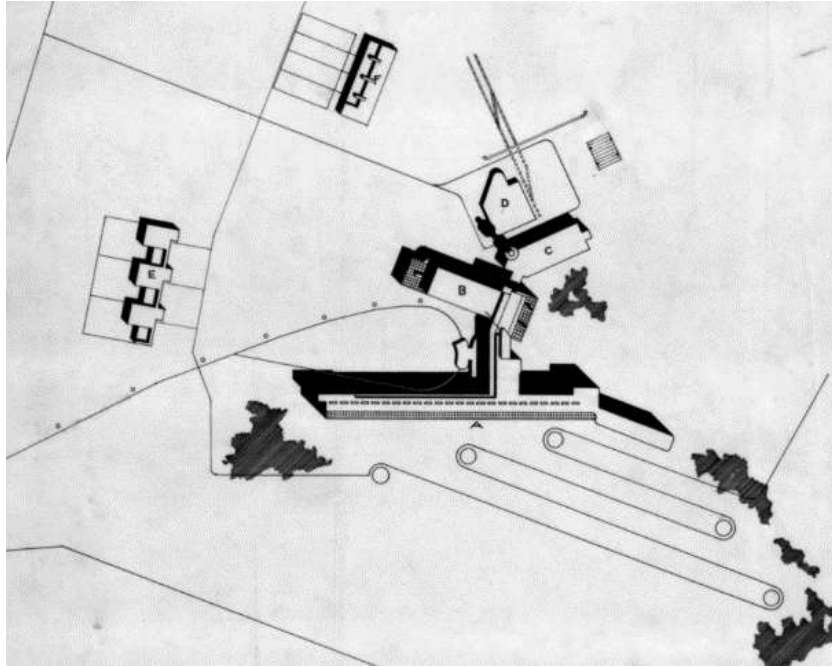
Planta de Implantação. Fonte: Fundação Alvar Aalto.
